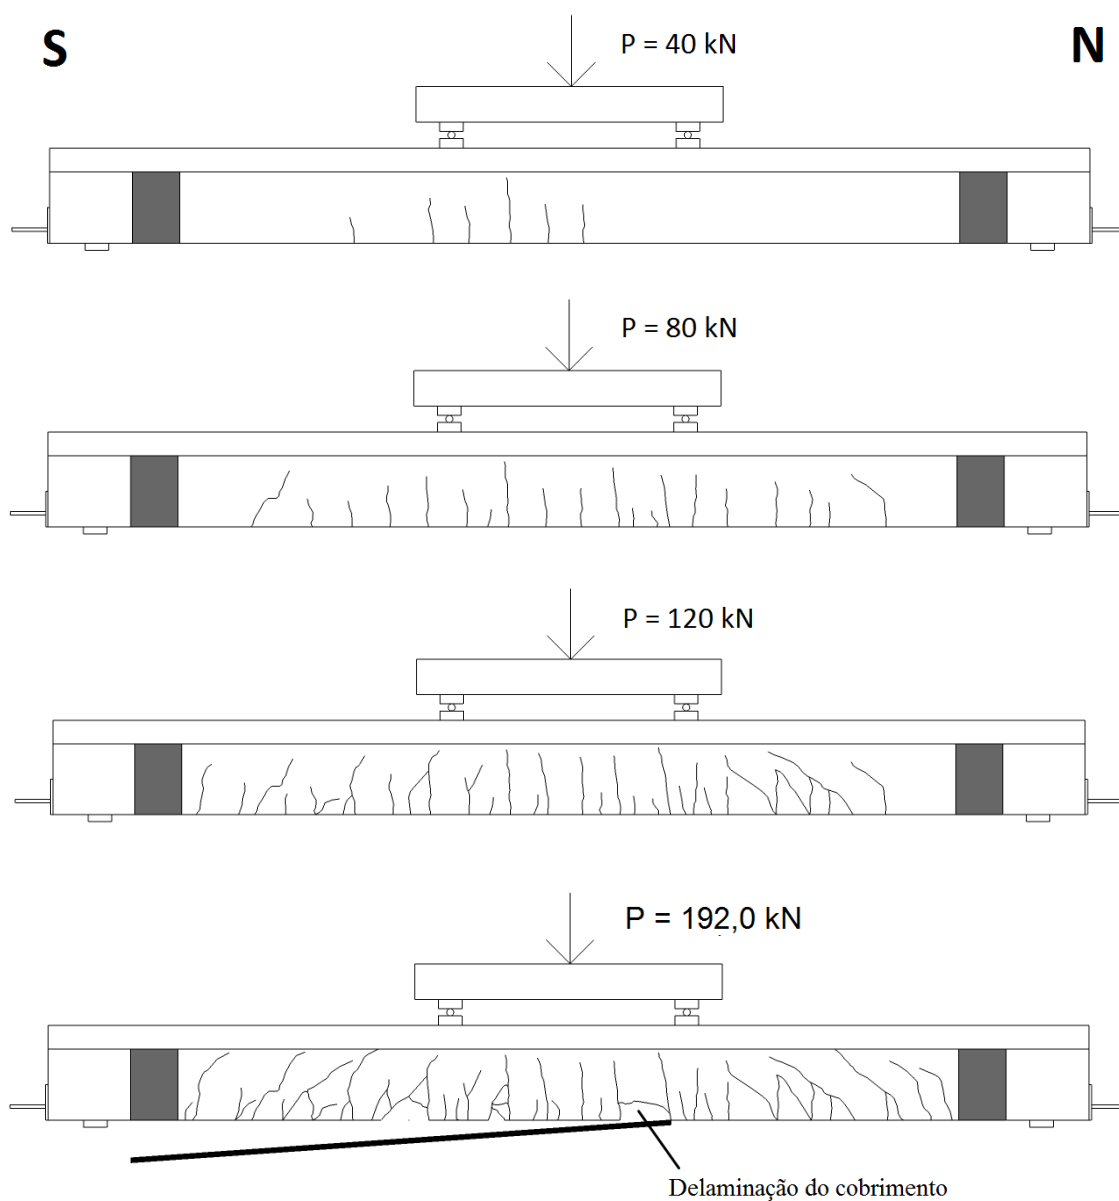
Evolução da fissuração na viga VA4 – VC
